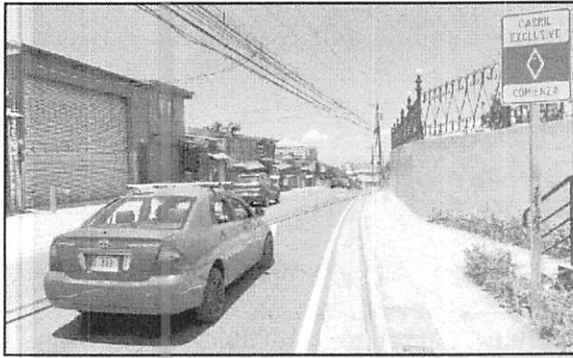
Ruta de Travesía N°40902, La Puebla, vista Este-Oeste.
